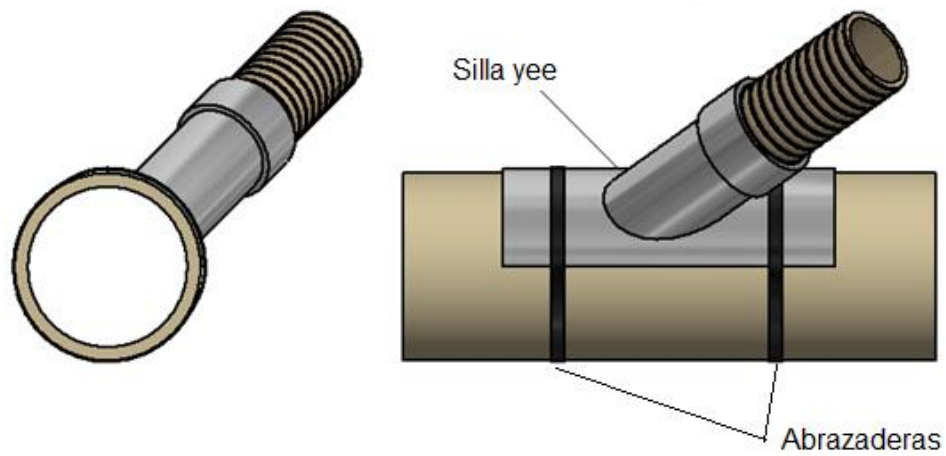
Conexión a tubería PVC con accesorio silla "yee"
